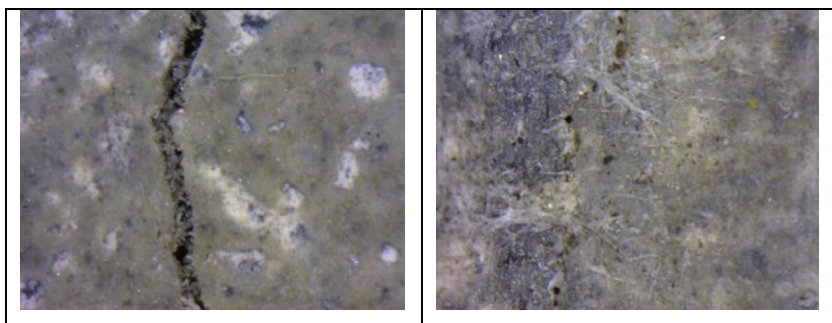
Imagem da fissura após pré-fissuração e, após autoreparo, provenientes de Ferrara *et al.*, (2014).
